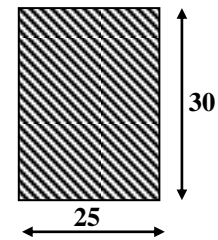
pré dimensionnement de la poutre palière.
